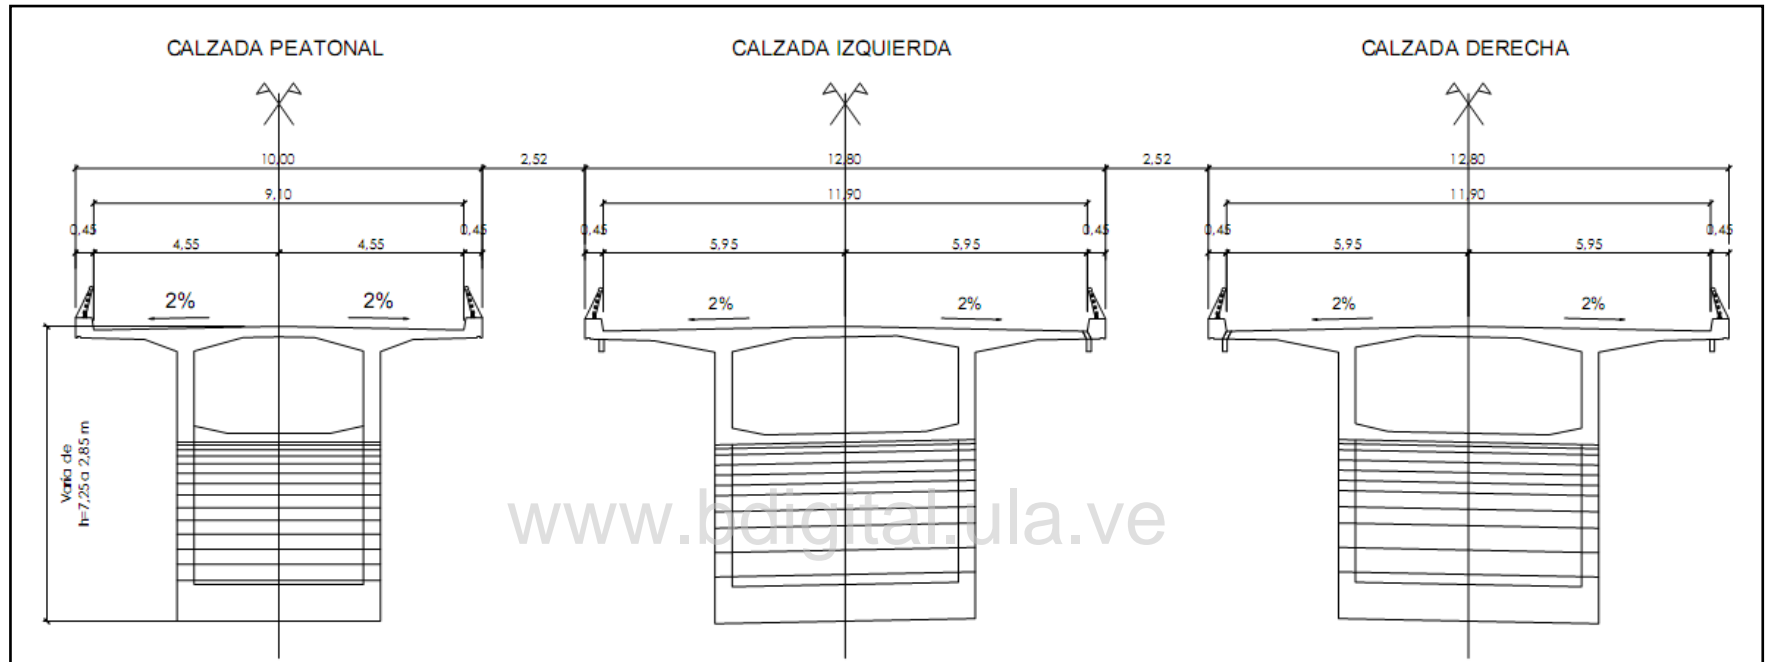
Sección Transversal Puente Binacional Tienditas
